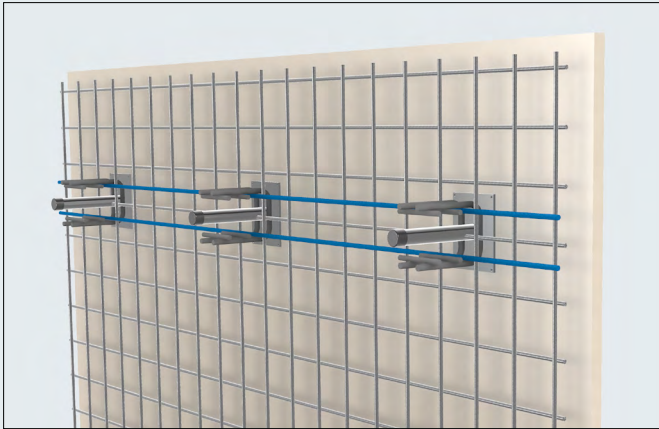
Querkräftdornhülsen auf Wandschalung montieren und Bewehrung verlegen (Abstände beachten).
